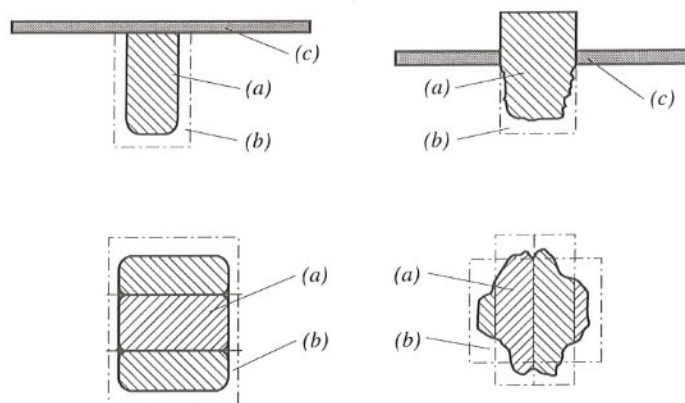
Sections de poutres et poteaux avant et après exposition au feu (extrait STEP)
